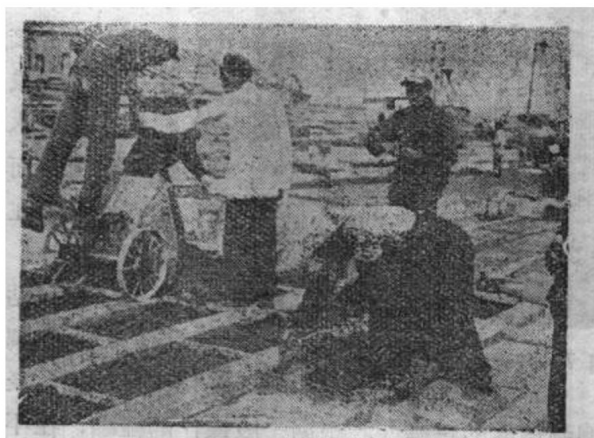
採用無底模板進行混凝土施工，圖中為塗刷乳膠、安裝鋼筋和澆灌混凝土流水作業之情況
